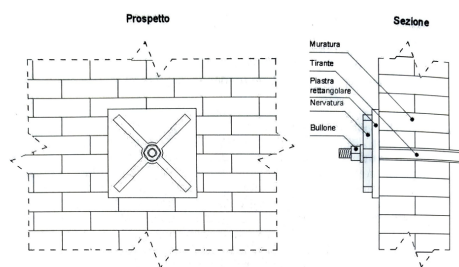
Capochiave rettangolare in prospetto e sezione.
